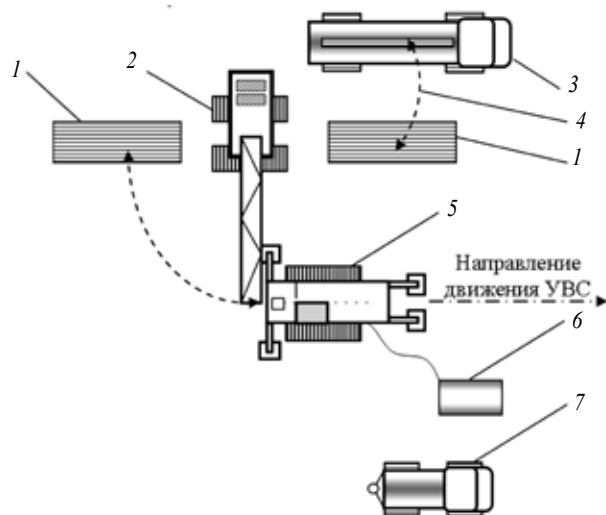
План-схема организации работ по вдавливанию свай: 1 – штабель свай на прокладках; 2 – гусеничный кран; 3 – автотранспортное средство доставки свай; 4 – траектория перемещения свай краном; 5 – самоходная УВС; 6 – силовая установка (может монтироваться на базе УВС); 7 – самоходная буровая установка на базе автомобиля
